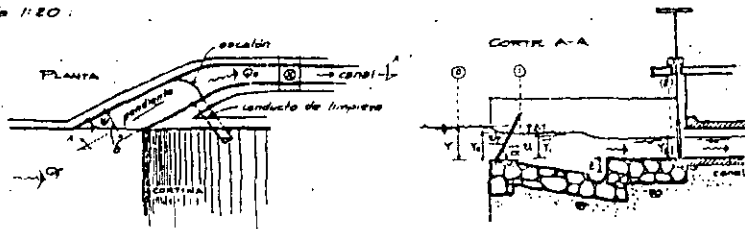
Esquema de la obra de toma. (Planta y corte.)
